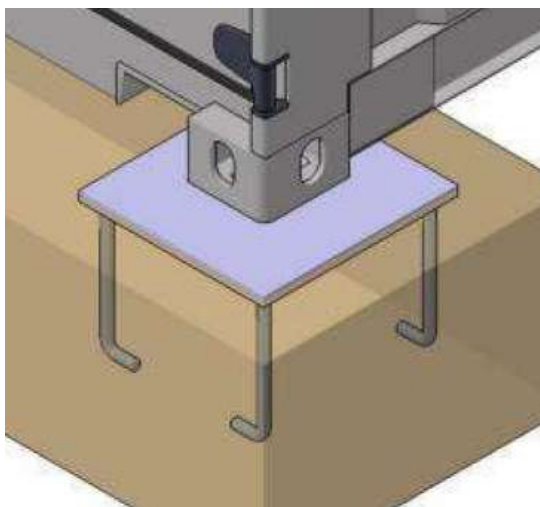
(1) illustrazione schematica delle piastre e sistemi di fissaggio
